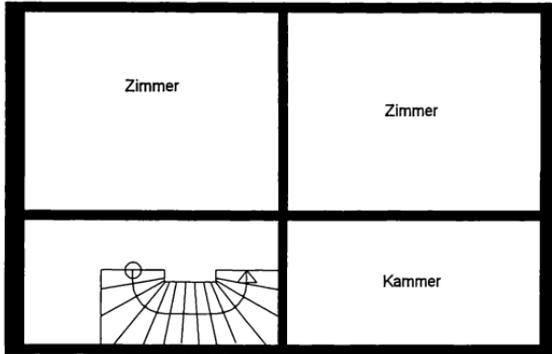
Kreuzgrundriss mit Durchgangszimmer und Kammer
